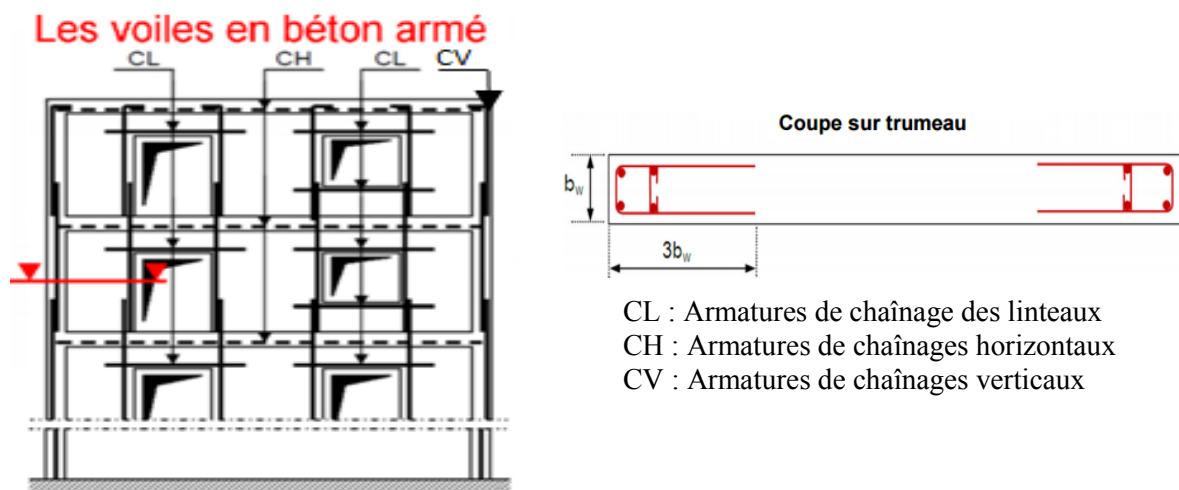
Dispositions constructives de renforcement parasismique dans les constructions en béton armé
